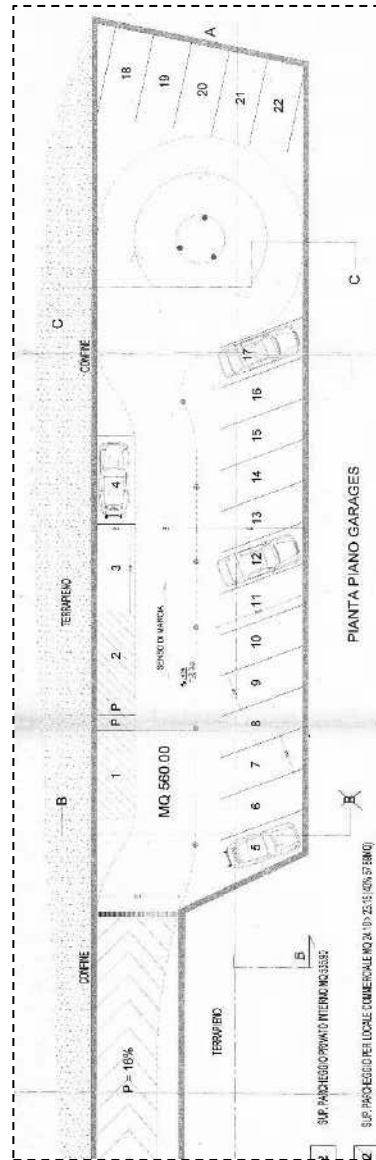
Planimetria dello stato di progetto – Piano Seminterrato
